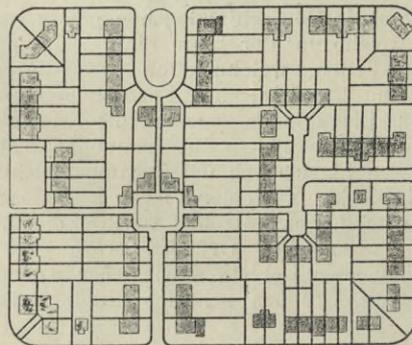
Zusammenstellung aus englischen Gartenstädten über halboffene Bauweise in Blöcken mit Sackgassen. 1:4000. Es werden ziemlich gleichmäßige Teilungen großer Blöcke und geringe Straßenbaukosten erreicht
